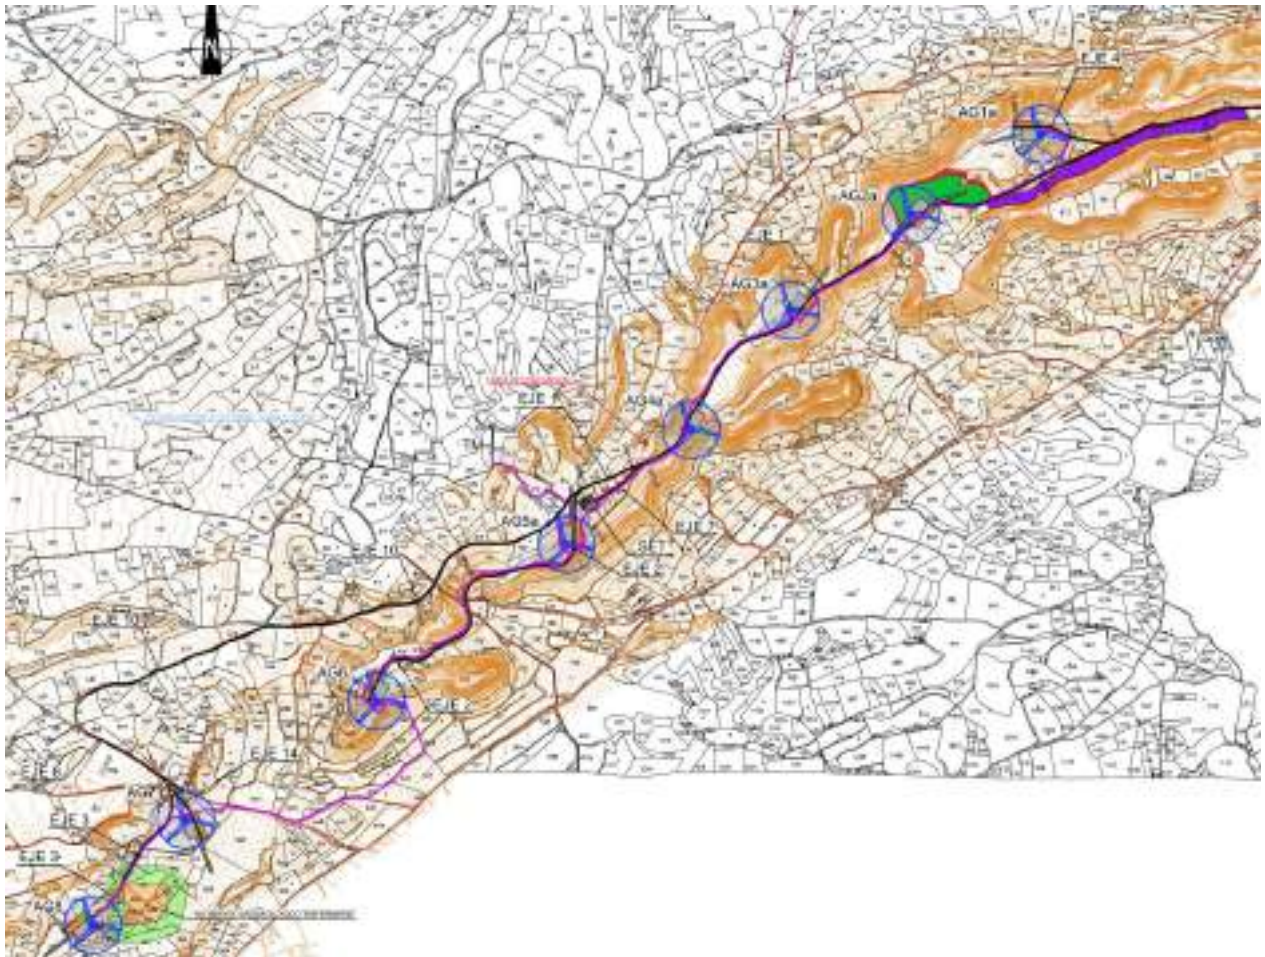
Vista general en planta del parque eólico Cascante II. Fuente: Propia
